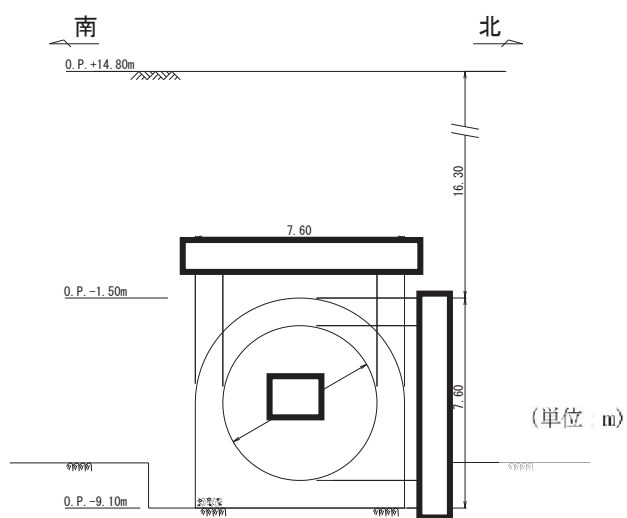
排気筒連絡ダクト断面図 (A-A 断面, 土砂部)
